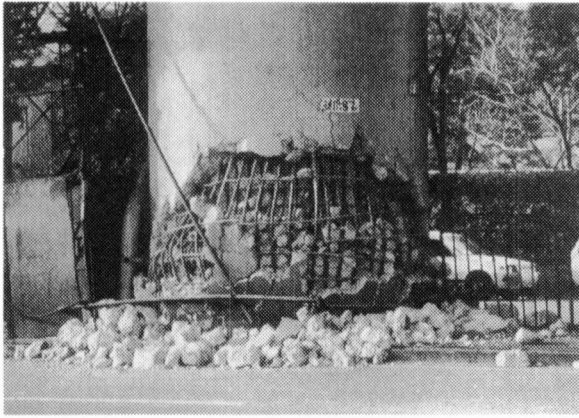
1. 2-1 R C橋脚の曲げ破壊
